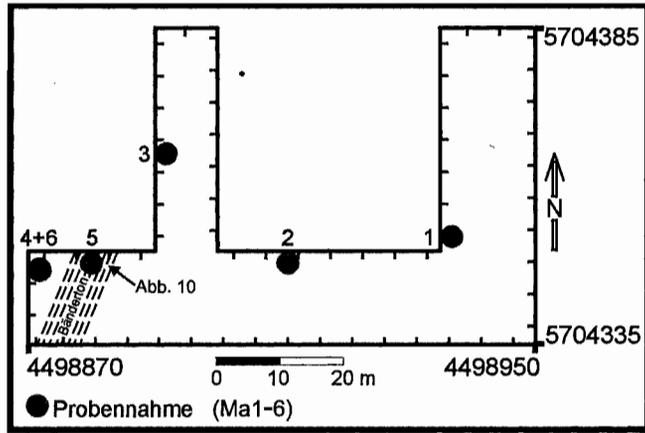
Grundriss der Baugrube für das Polizeipräsidium (mit Gauss-Krüger-Koordinaten)
